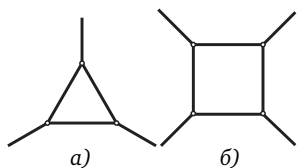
Схемы крепления оттяжек к стволу мачты:
